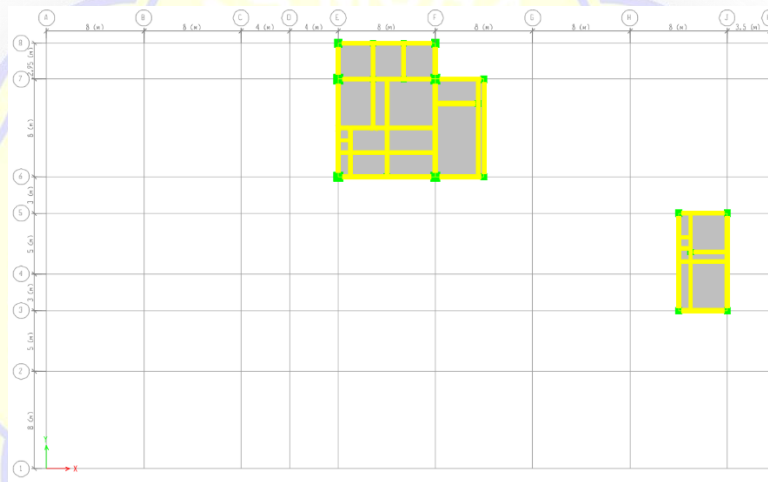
Denah Pemodelan lantai 2,3 dan 4
